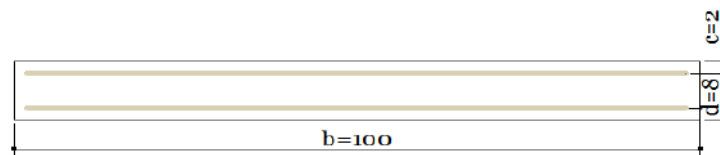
Section théorique pour le ferrailage de l'acrotère.
